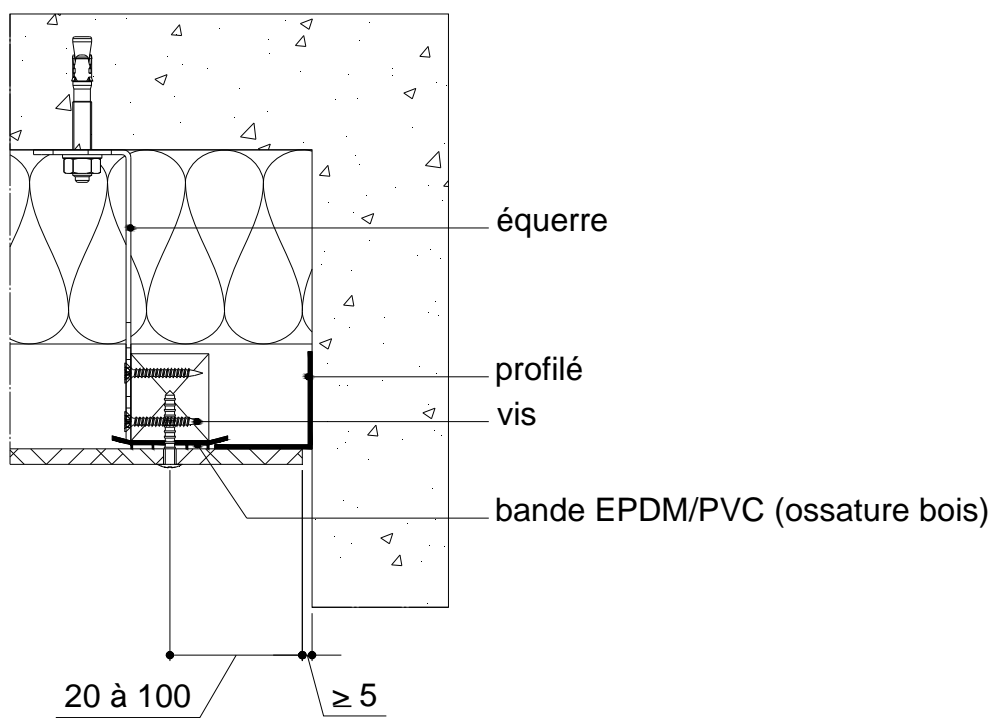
Détail connexion contre un mur sans bardage (coupe horizontale) sur ossature bois ou métallique (cote en mm)
